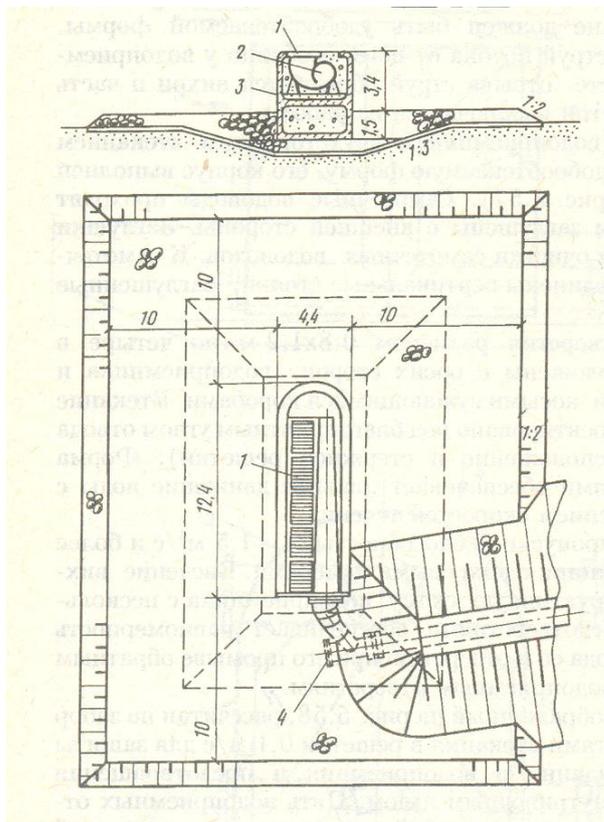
Фильтрующий железобетонный водоприемник с вихревыми камерами, двухзвенный
